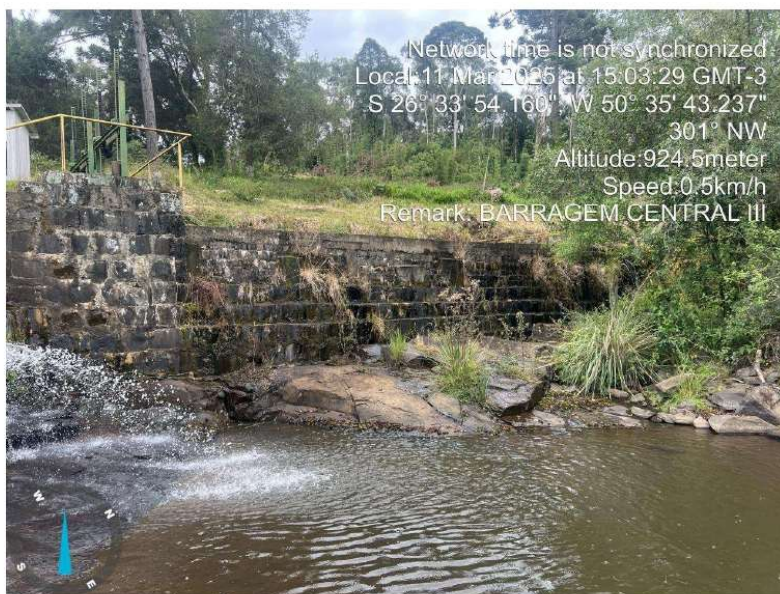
SURGÊNCIAS NO BLOCO DE PEDRA ARGAMASSADA CANAL
